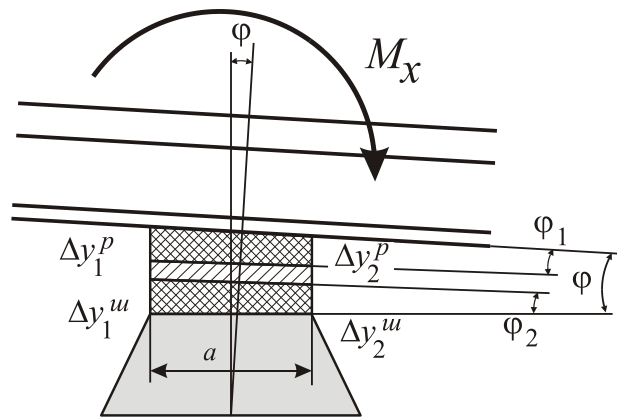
Расчетная схема для определения угла поворота сечения рельса
